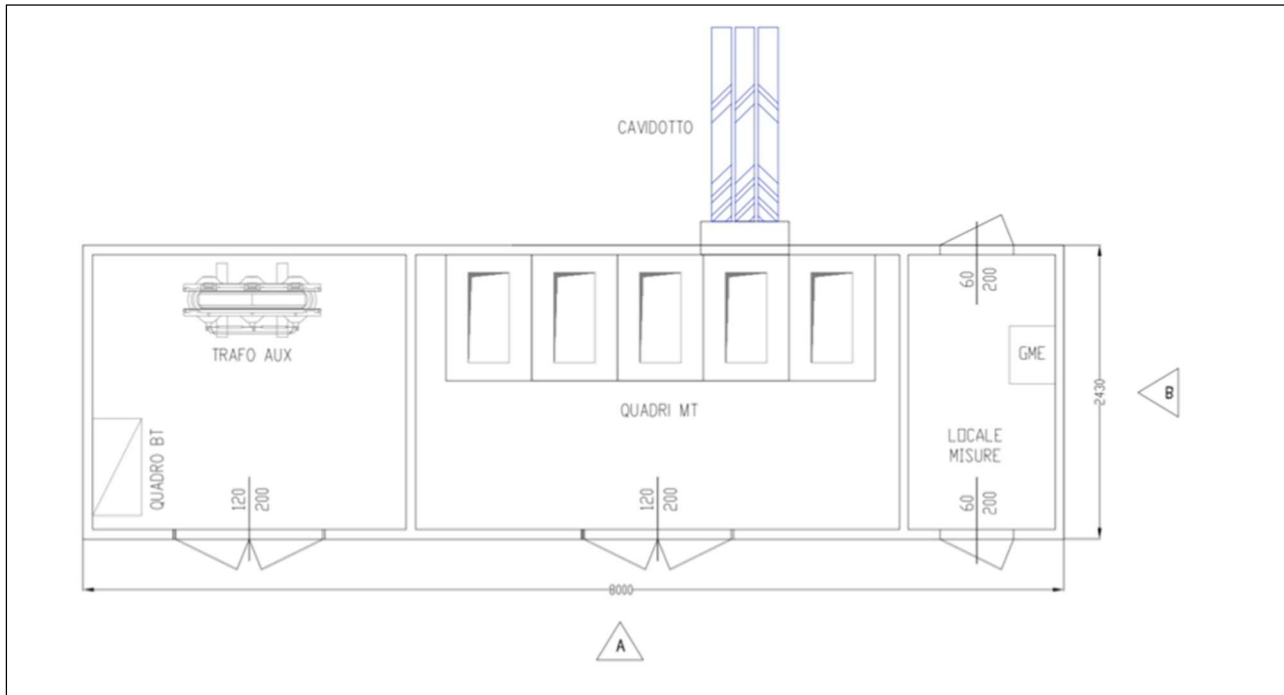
Locale cabina di Parallelo MT- Prospetto
